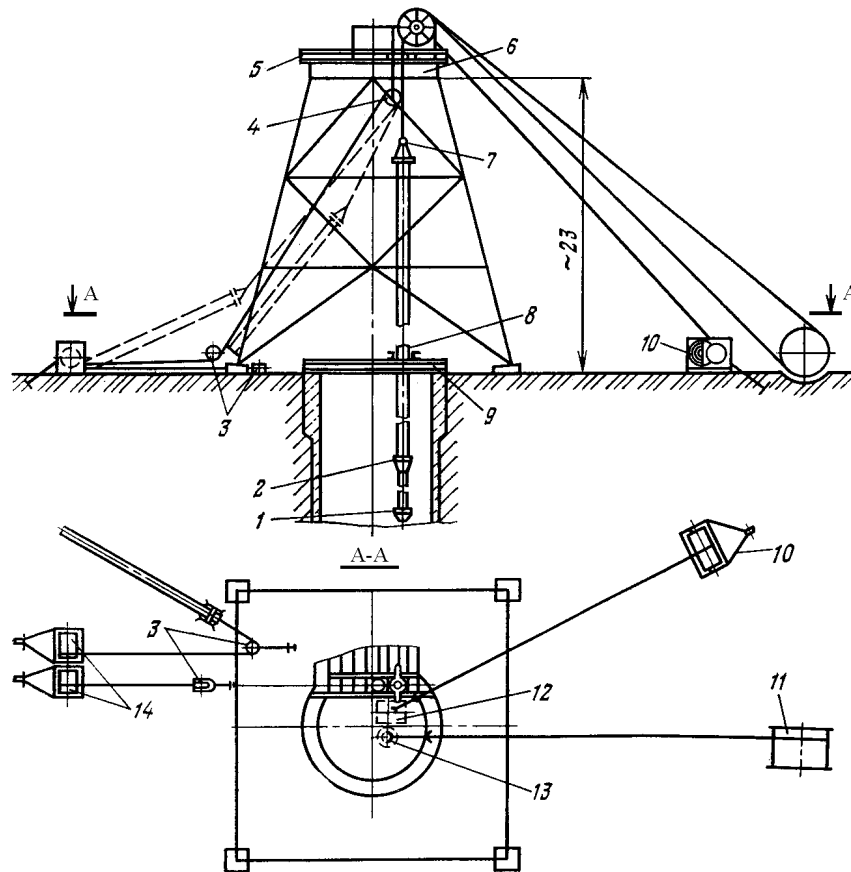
Схема монтажа трубопровода с проходческого копра:
